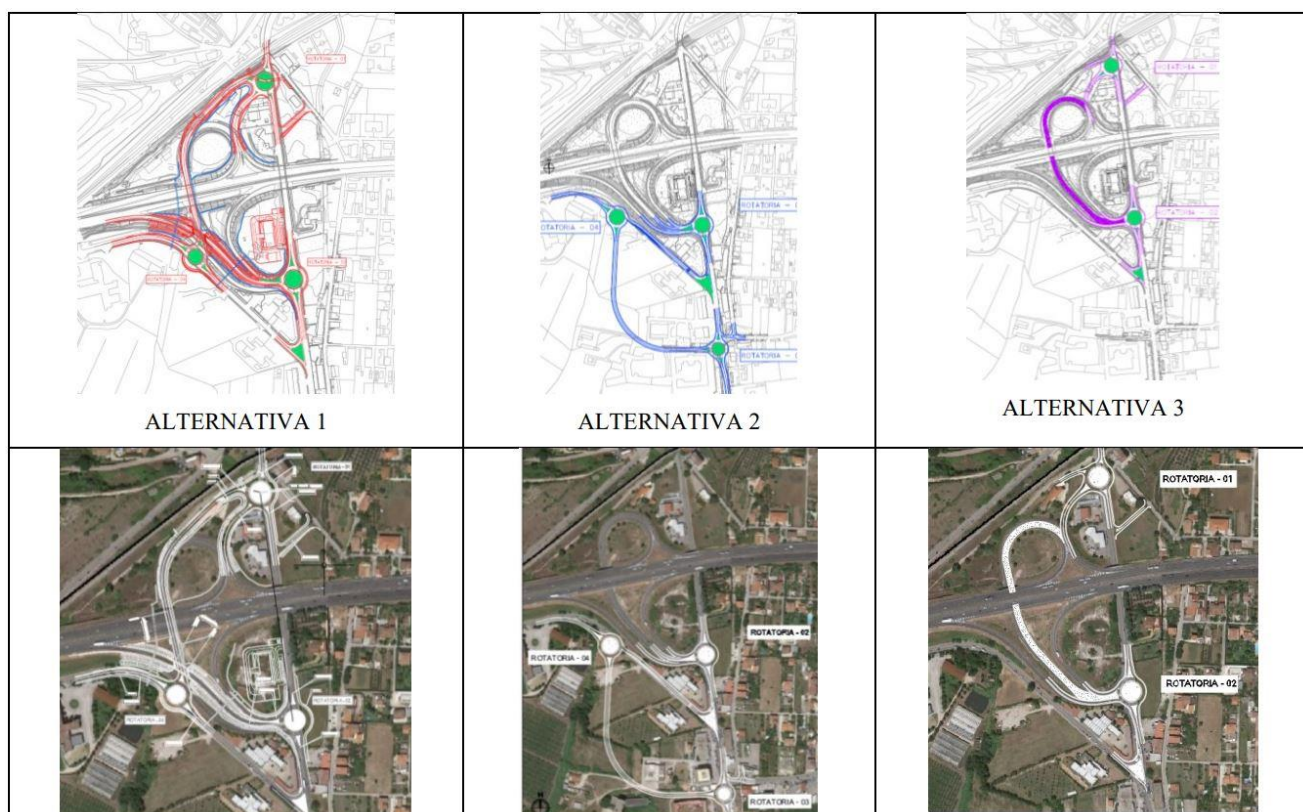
Estratti planimetrici di progetto con la rappresentazione delle tre soluzioni progettuali proposte.
